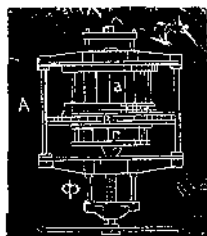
Парадѣйствующій коперъ: А—станокъ; а—барабанъ для подъема бабы; с—шкивъ для привода отъ машины; с—барабанъ для подъема свай.
